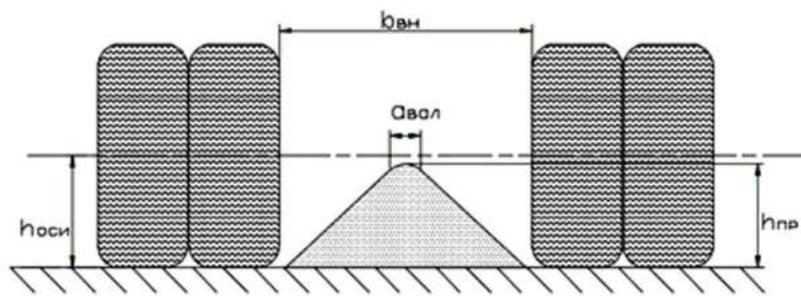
Схема формирования валика между задними колёсами самосвала
